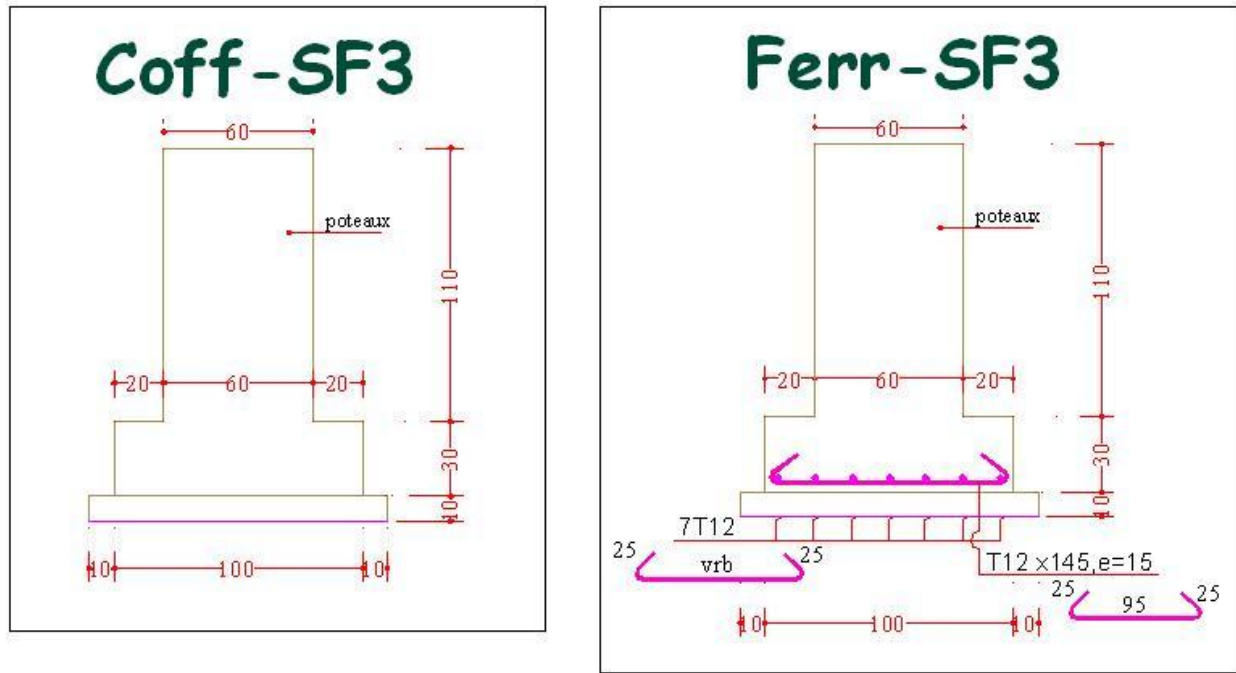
Dimensionnement et ferrailage forfaitaire de la semelle SF3
